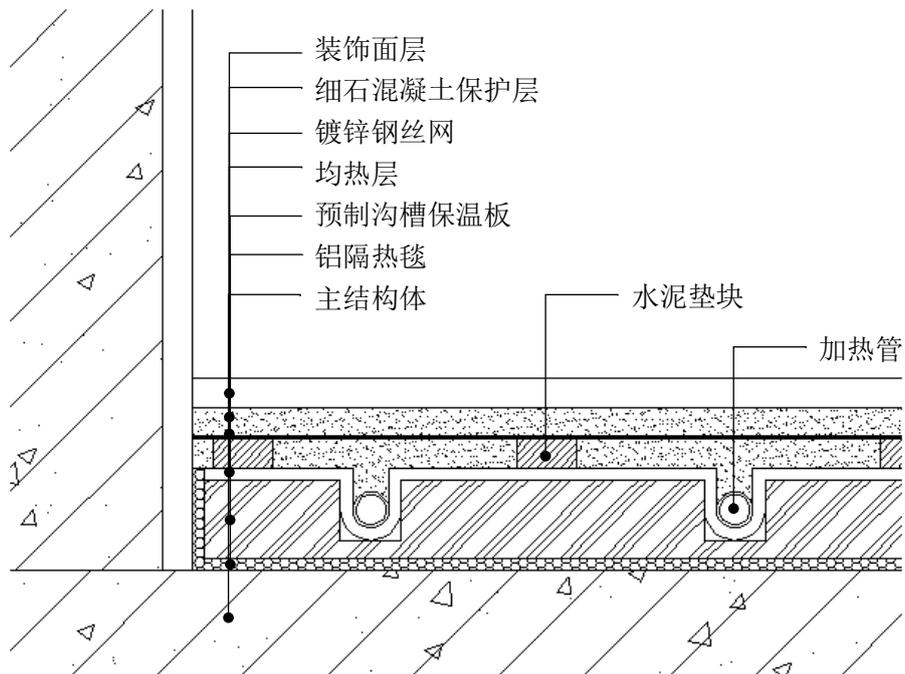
钢筋混凝土楼地面构造（预置保温板地暖构造）
